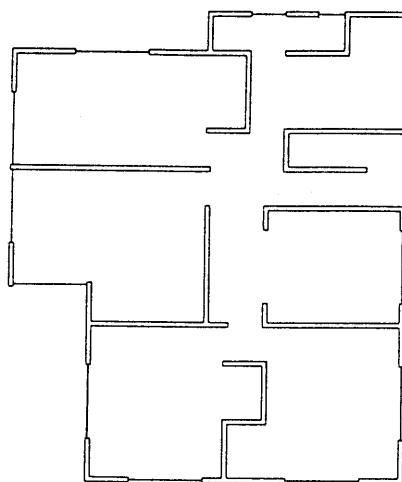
解析対象建築物平面図 (No.19, No.20)
